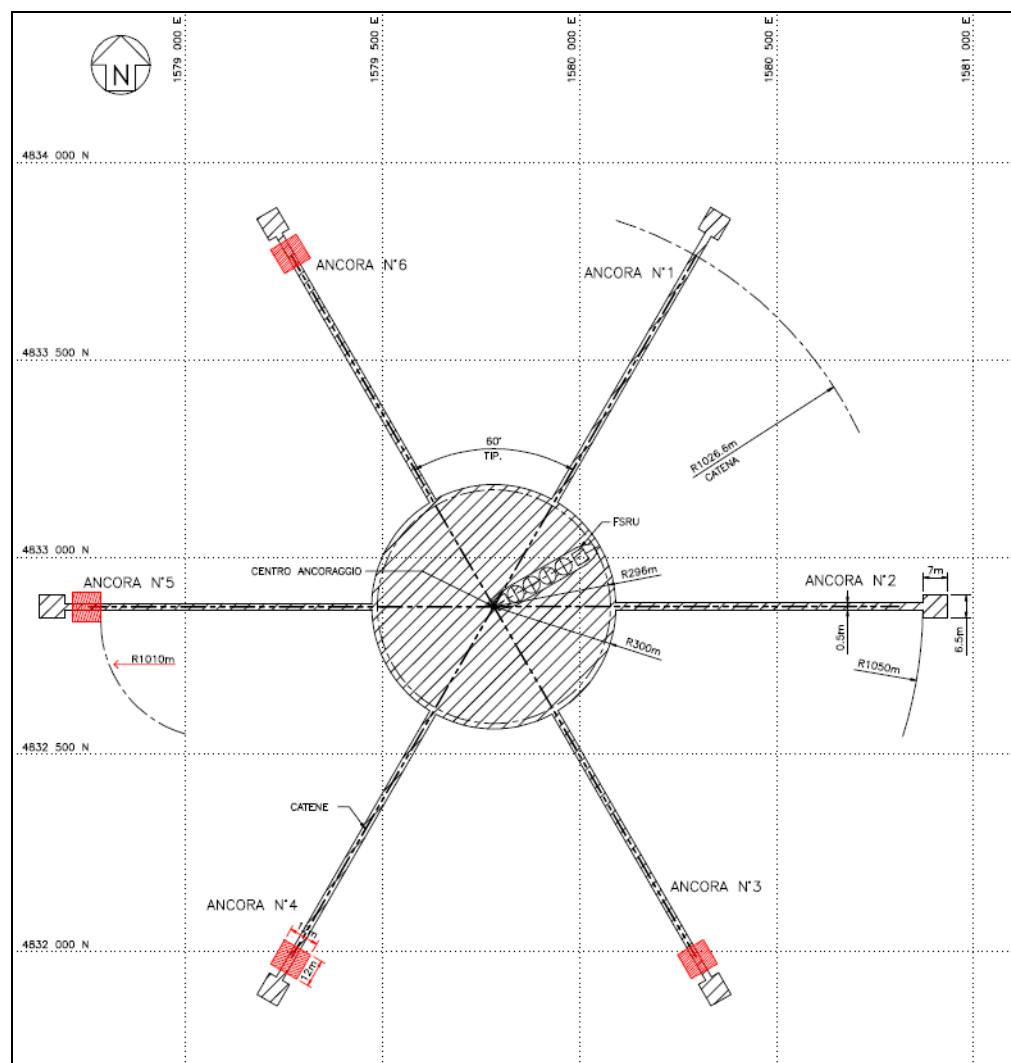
Ubicazione delle Ancore Rispetto al Terminale
